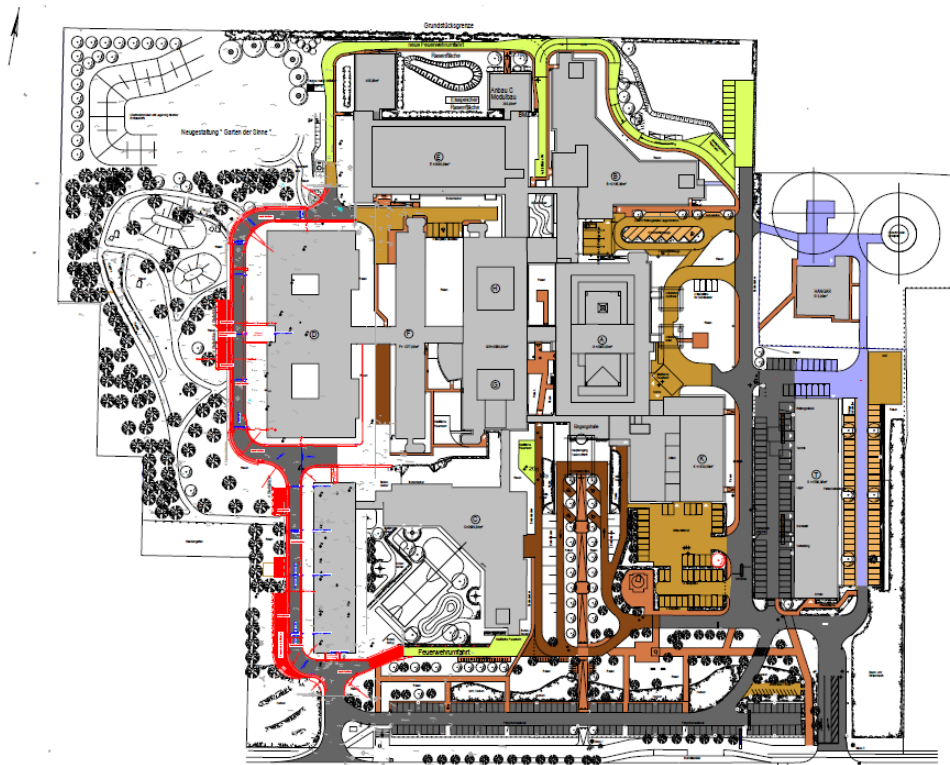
Lageplan mit Erweiterungsbauten (ascania AU_BAU_AU_LP_!___a_130529)
